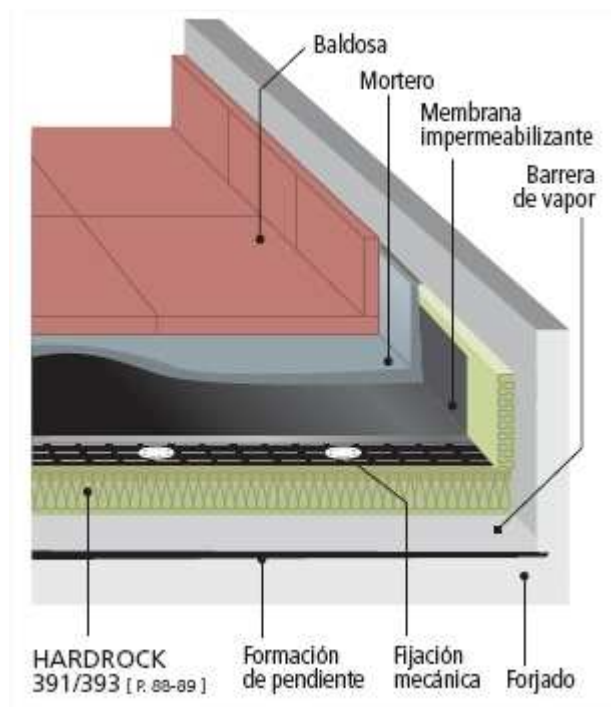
Esquema aislamiento cubierta (Fuente: Rockwool)
